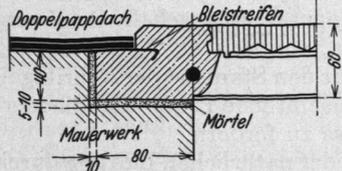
Anschluß eines Doppelpapdaches an ein eingelegtes Glasbeton-Dachoberlicht.
